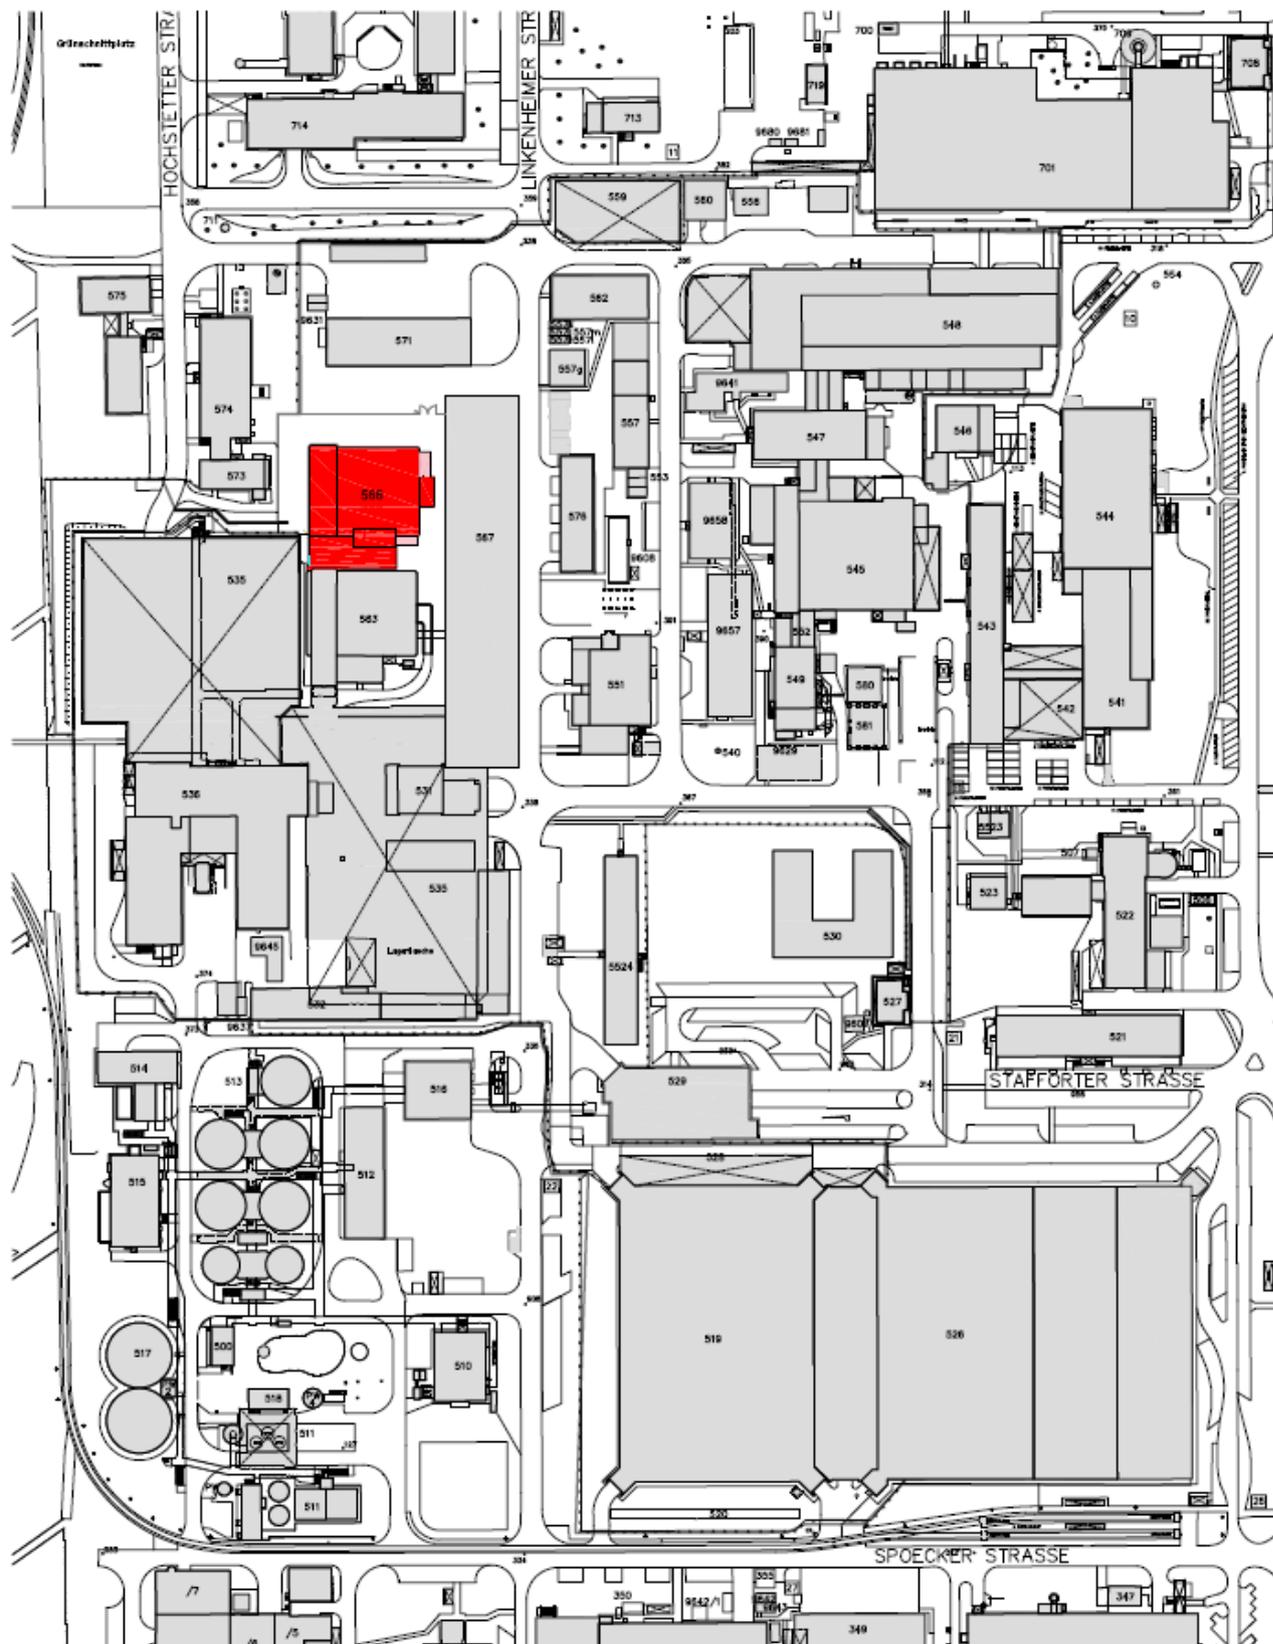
Lageplan der HDB, das rot gekennzeichnete Gebäude stellt das Lagergebäude L566 dar
